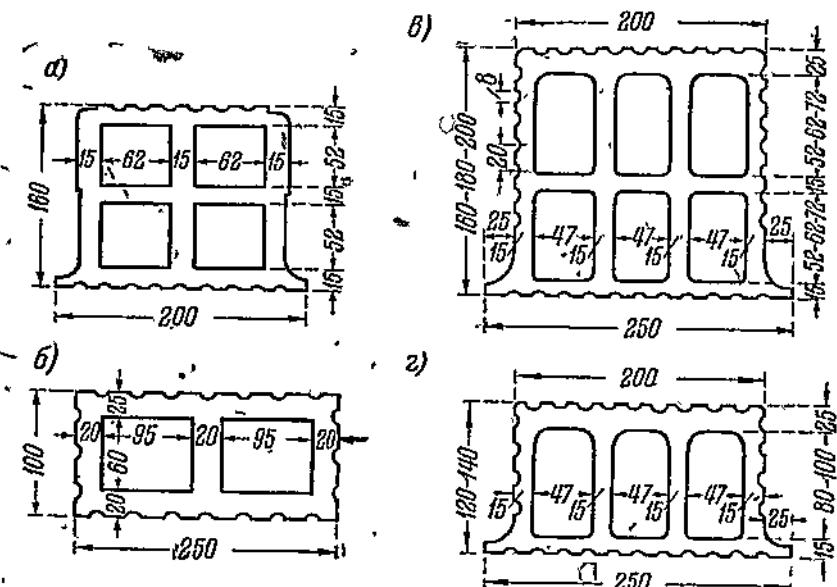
Типы керамических камней для перекрытий, предложенные ЦНИПСом.
